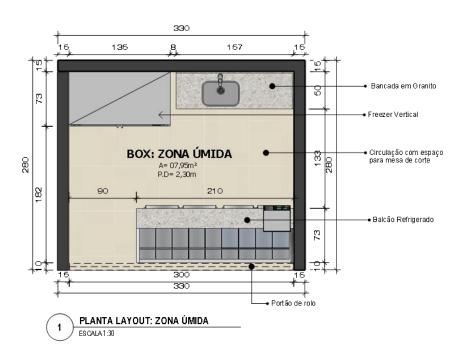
PLANTAS DE LAYOUT: BOX ZONA ÚMIDA
